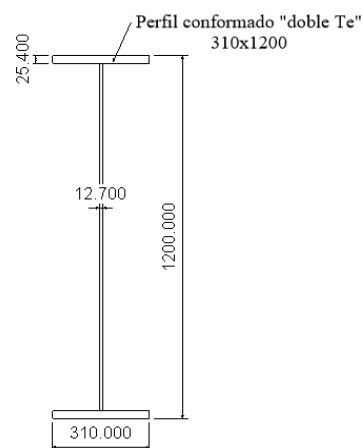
Ubicación de viga inferior central de marco metálico apoyado. Fuente: Autor.
